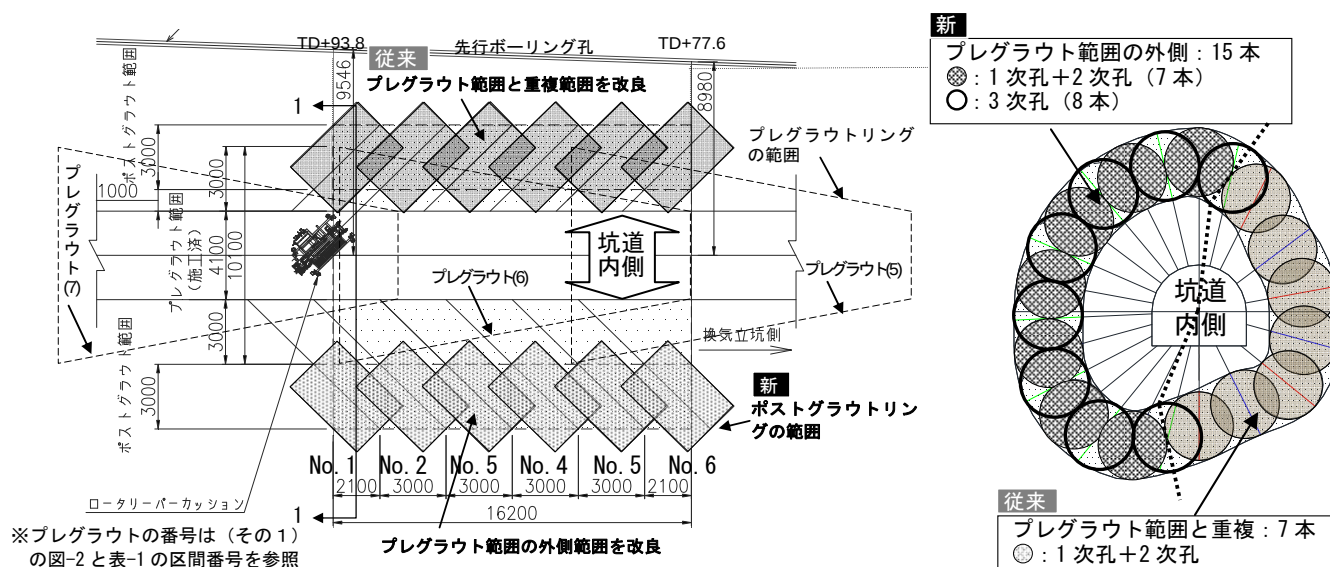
ポストグラウトリングの配置図 (左：平面図, 右：横断面図 (1-1 断面))
